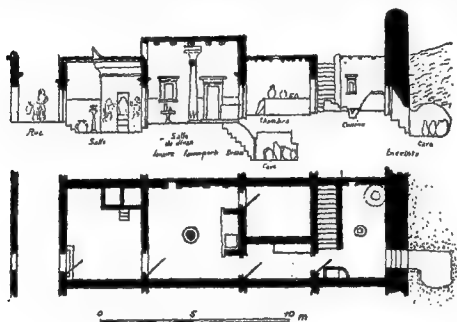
Plan type d'une maison à Deir el Medineh.
